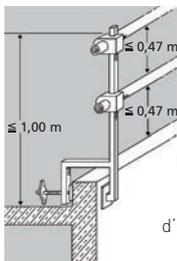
Exemple de protection latérale par tubes d'échafaudage au niveau de l'arête du toit
